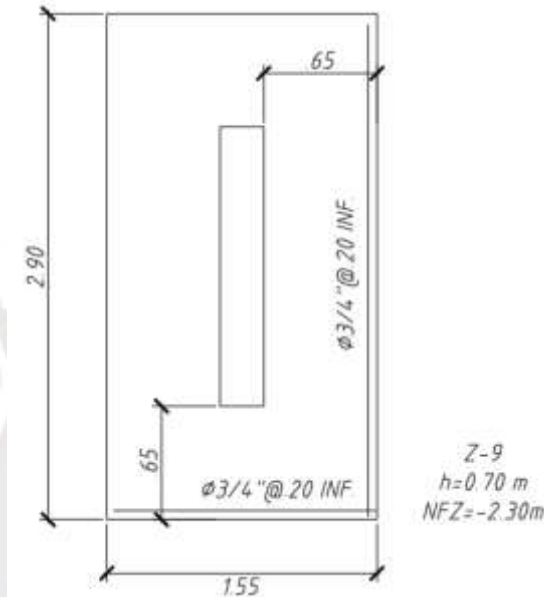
Disposición de acero de refuerzo en la zapata Z-9
